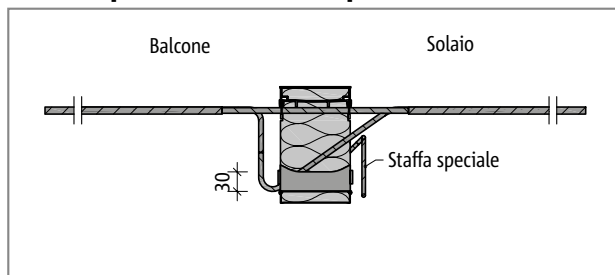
Schöck Isokorb® tipo KXT55 – KXT100: sezione dell'elemento
